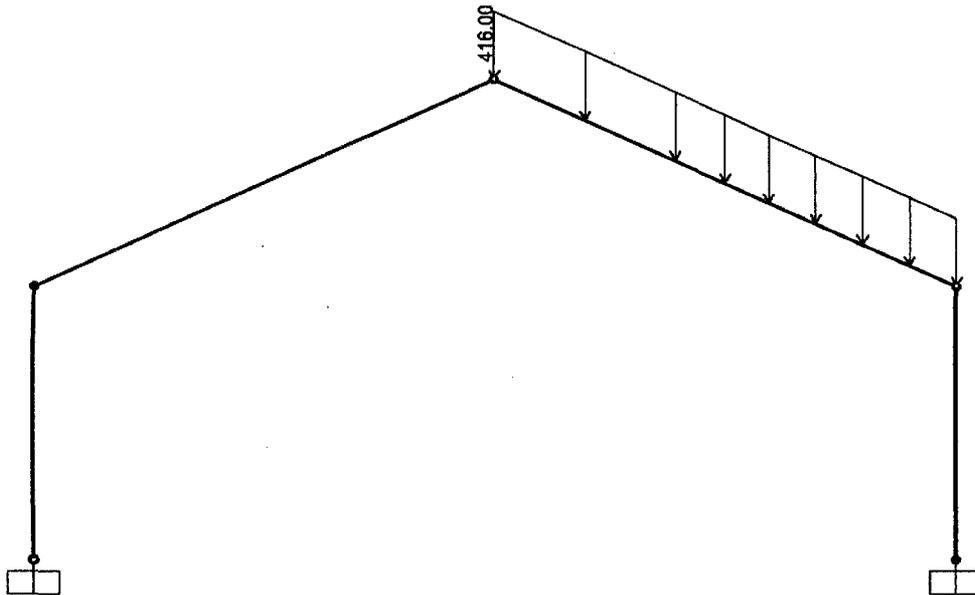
Sobrecarga en el Techo (Lr)
